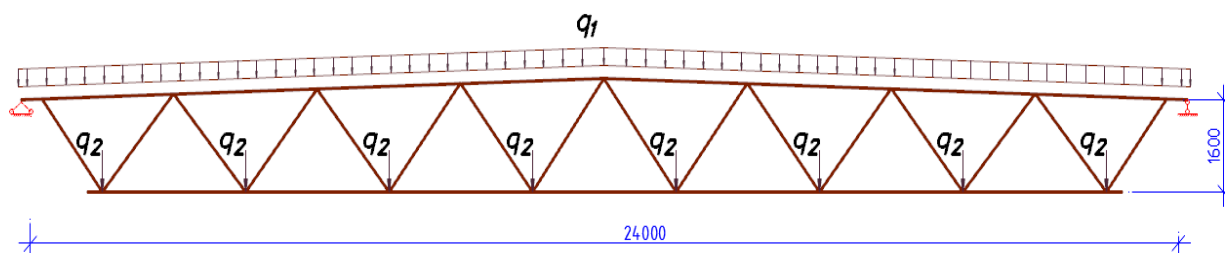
Схема заужения стропильной фермы постоянной нагрузкой
